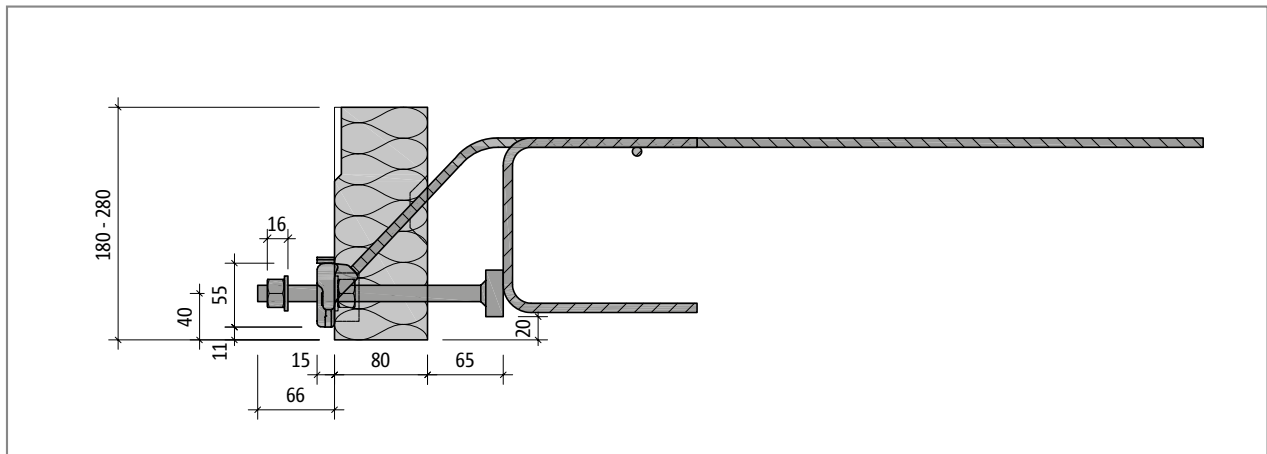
Schöck Isokorf® T type SQ-V3: Bovenaanzicht
